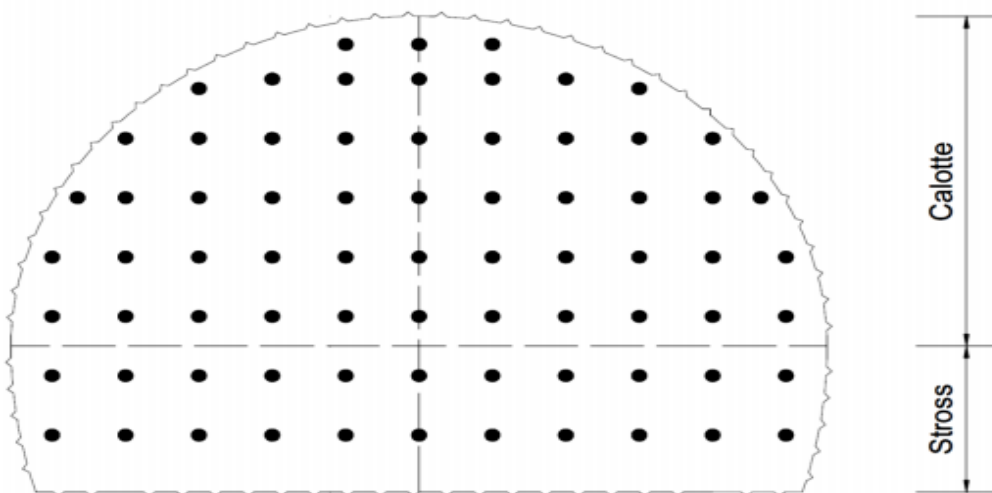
Plan de tire, [CHOUFI, 2018]
